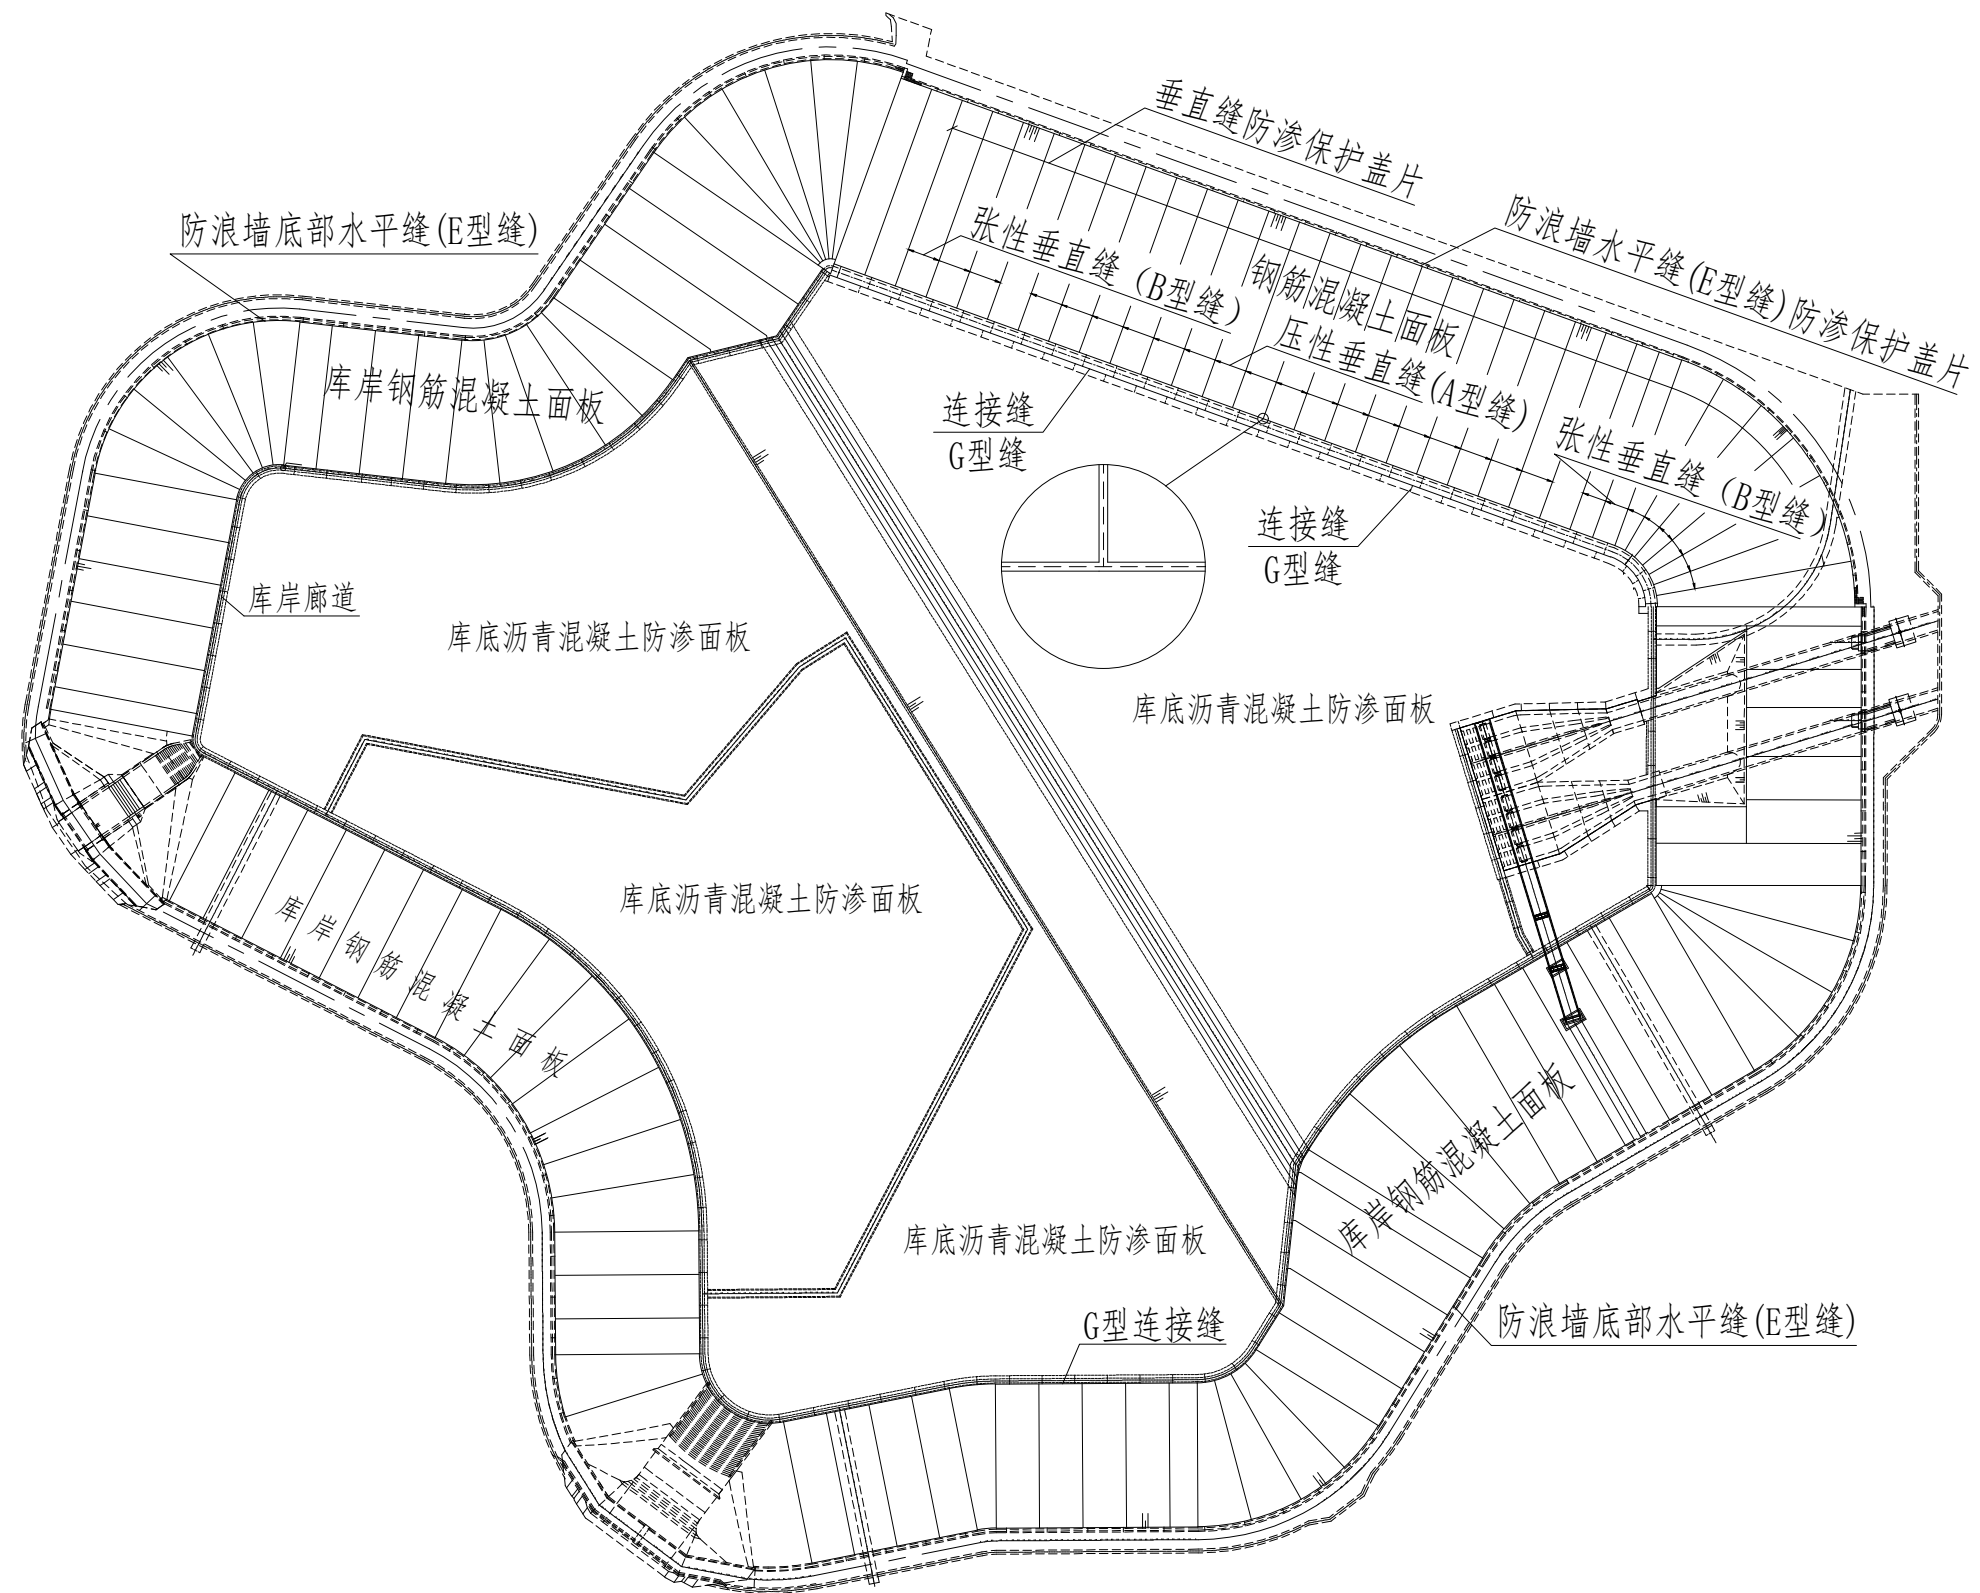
抽水蓄能全库盆防渗面板堆石坝防渗保护盖片平面布置图
